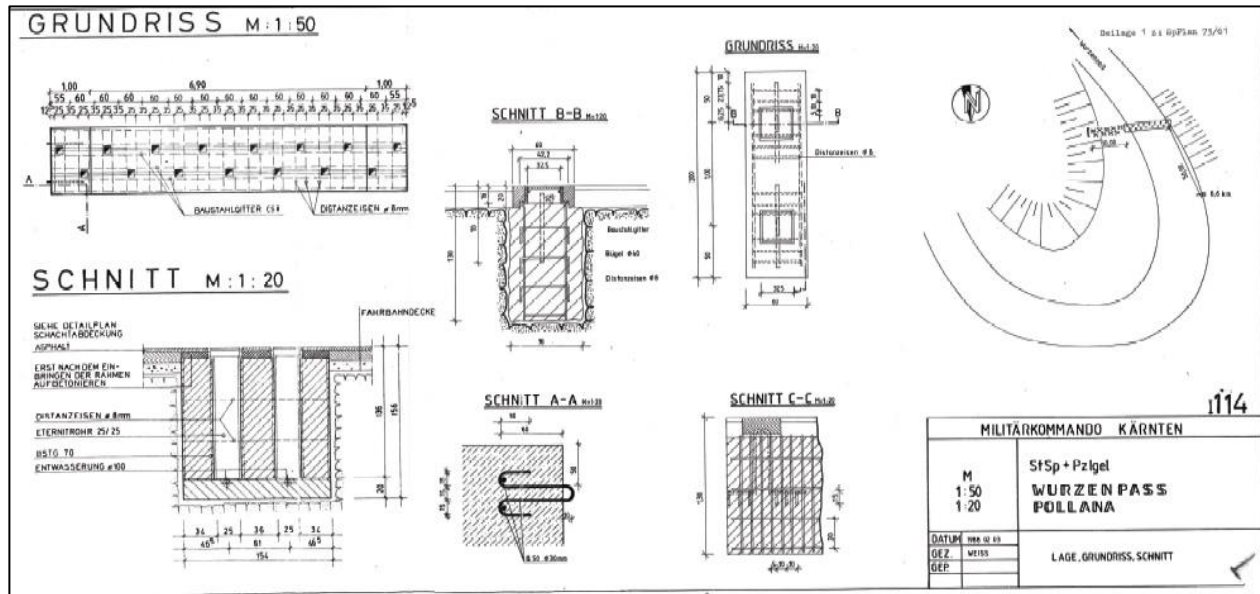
Sperrplan Sperre 73/61, Beilage 1 (MilkdoK) [*Verschluss]
